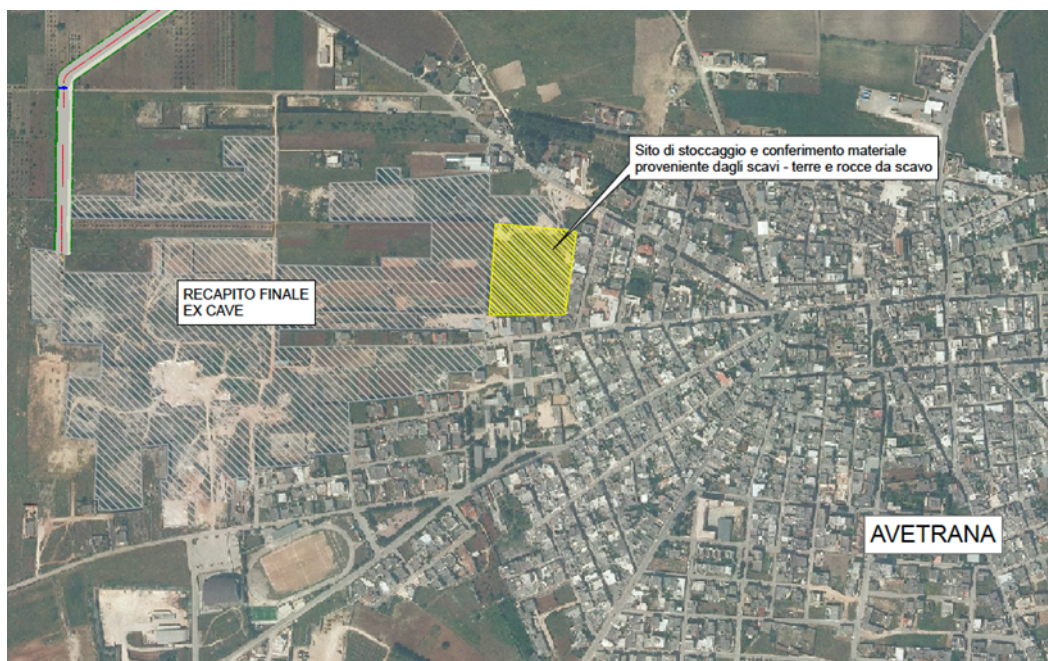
Planimetria ubicazione cave di riutilizzo
